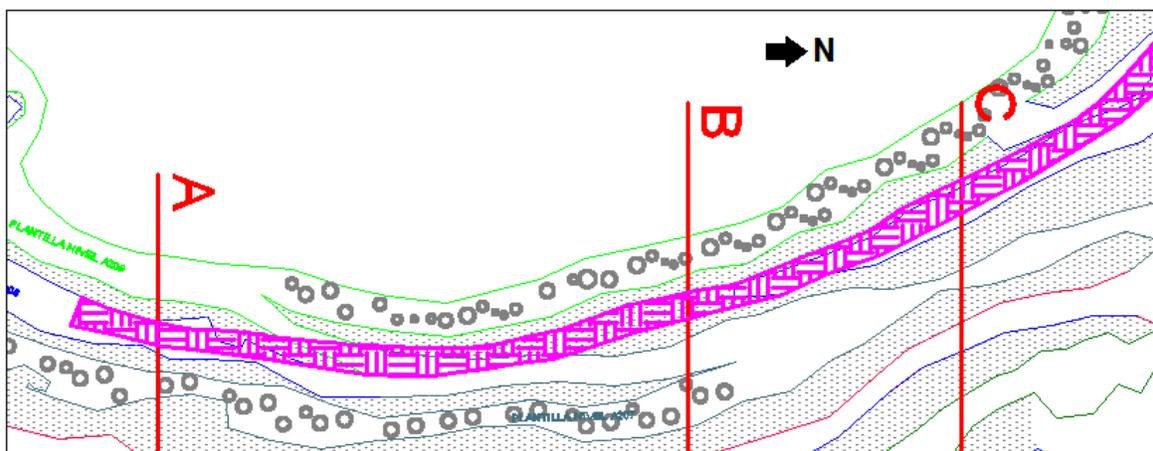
Construcción del nivel A208 a lo largo de las tres secciones.
